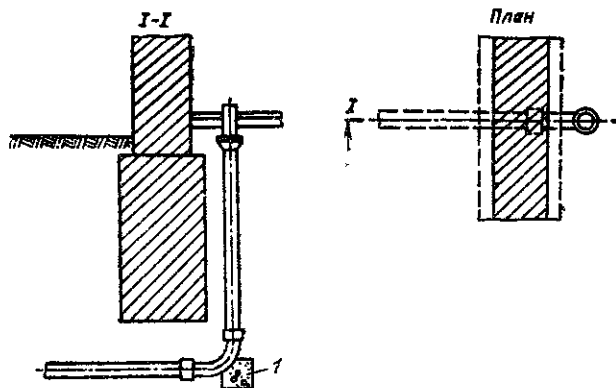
Ввод водопровода при ленточном фундаменте
